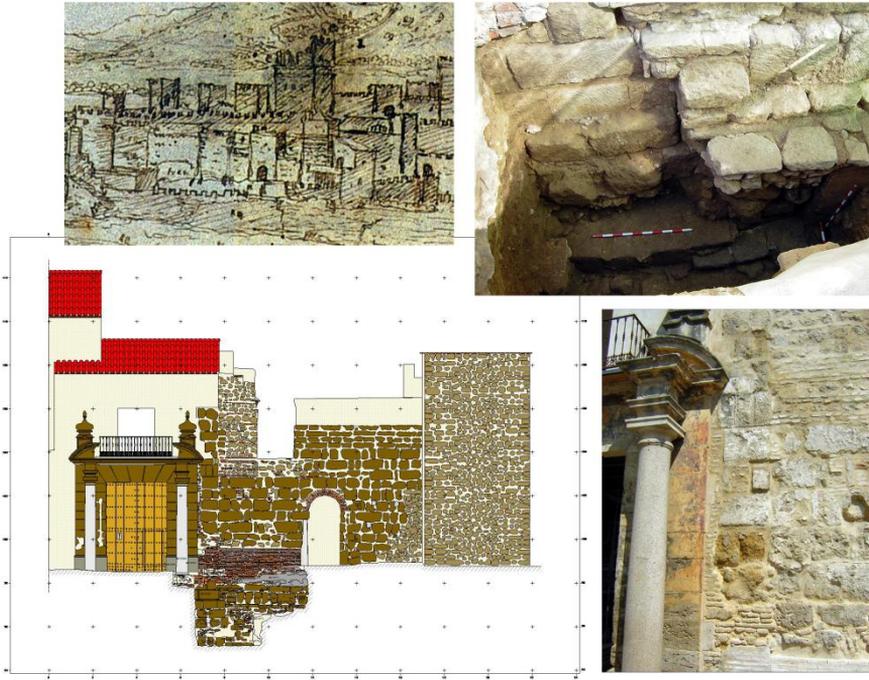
Restos de la portada almohade. Alzado de la portada actual; detalle del dibujo de Wynyaerde; y estructuras de sillería excavadas al pie de la fachada exterior del alcázar
